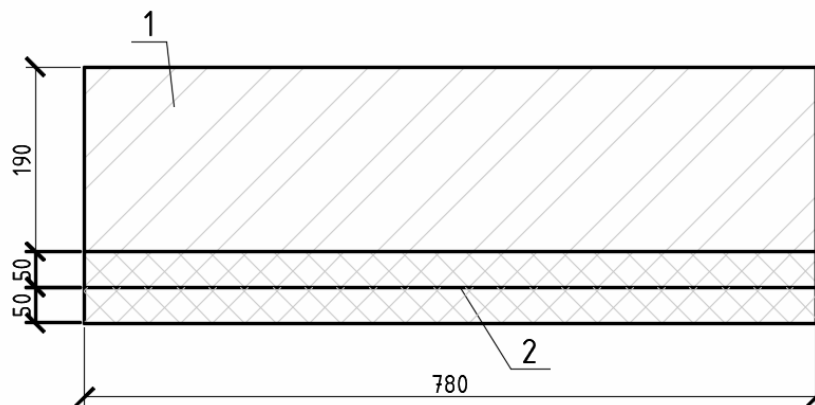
Схема сечения стены по кладке со 100 мм утеплителя без дефекта
